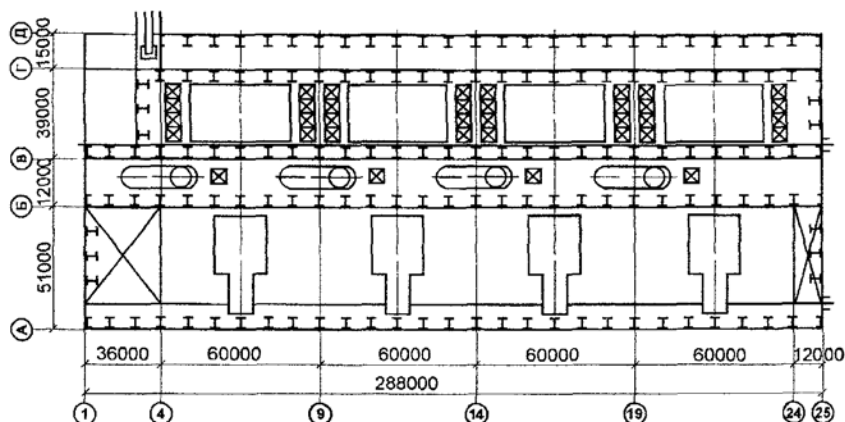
Пример плановой компоновки главного корпуса ТЭС
